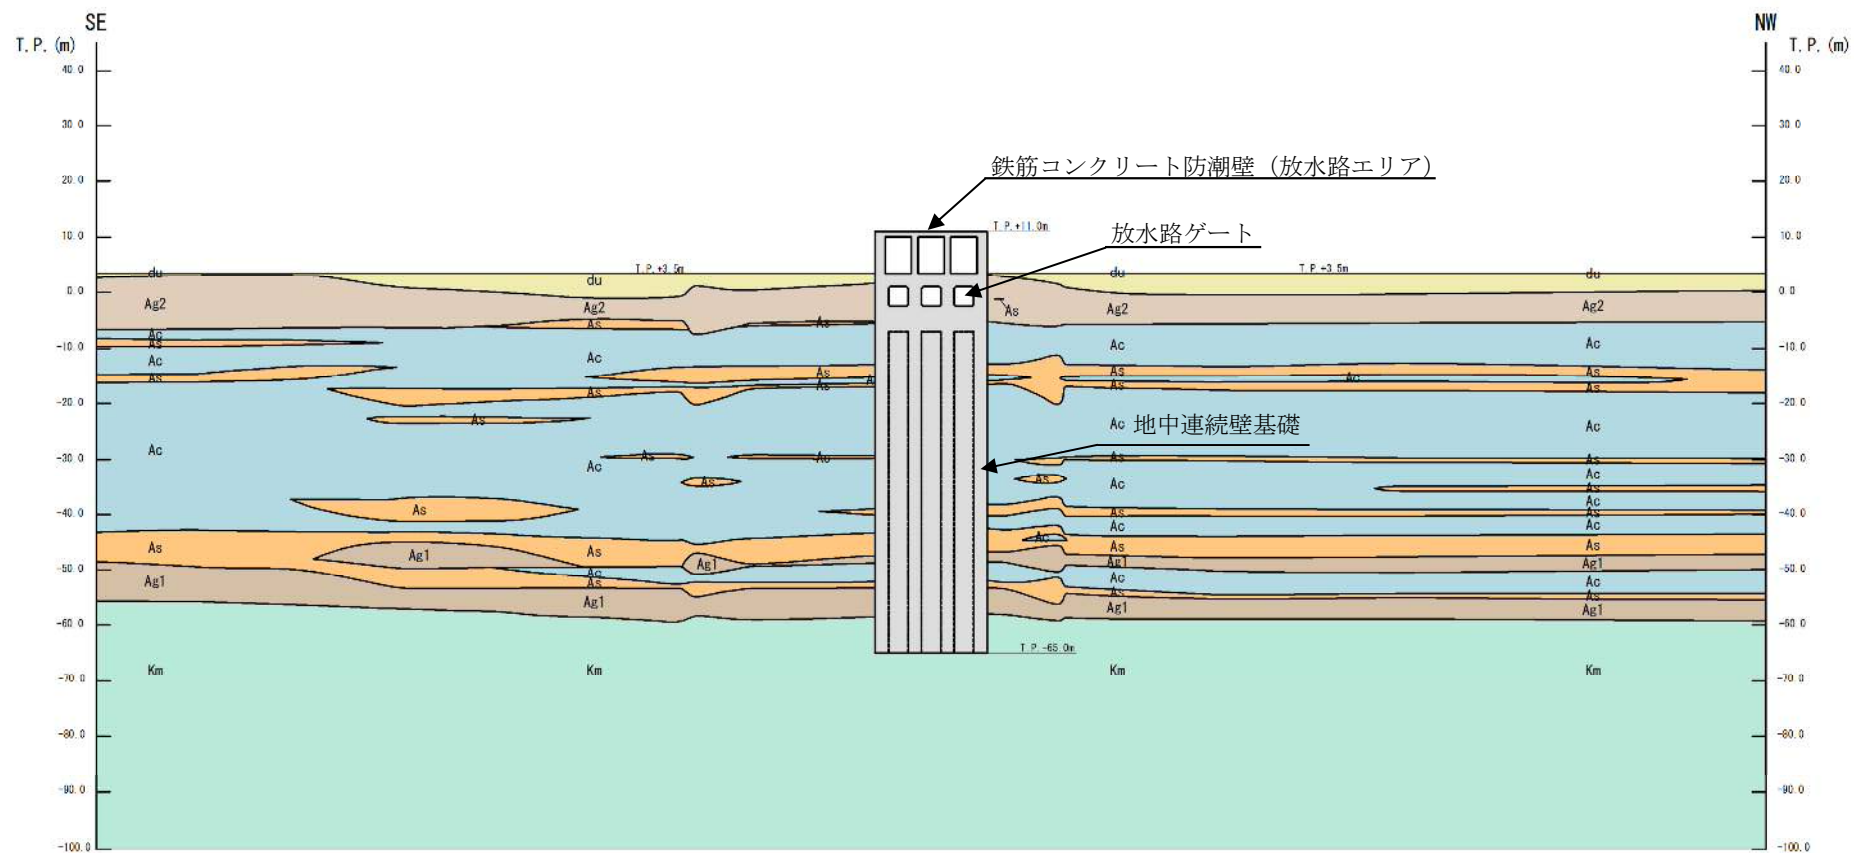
鉄筋コンクリート防潮壁（放水路エリア）の断面図（防潮壁縦断方向：③-③断面，ゲート部）
